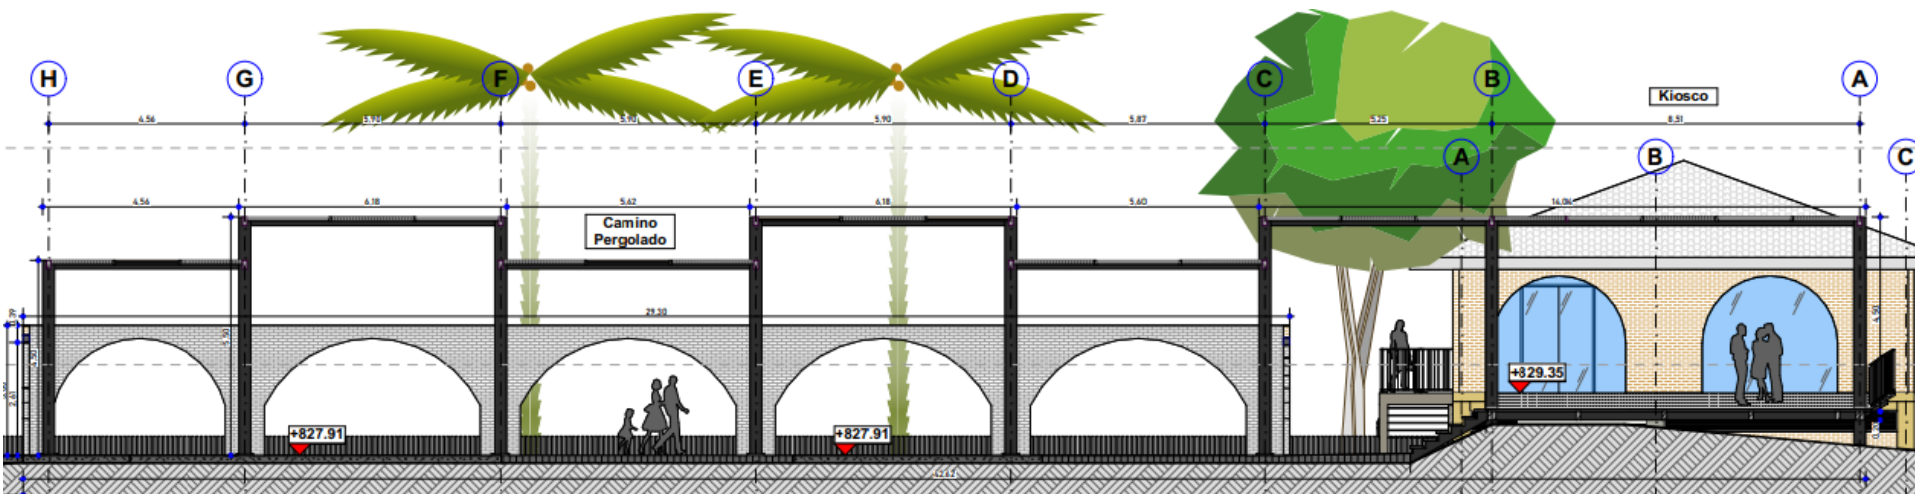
Vista en planta del camino pergolado del Plano Arquitectónico. Fuente Constructora sueños reales.
